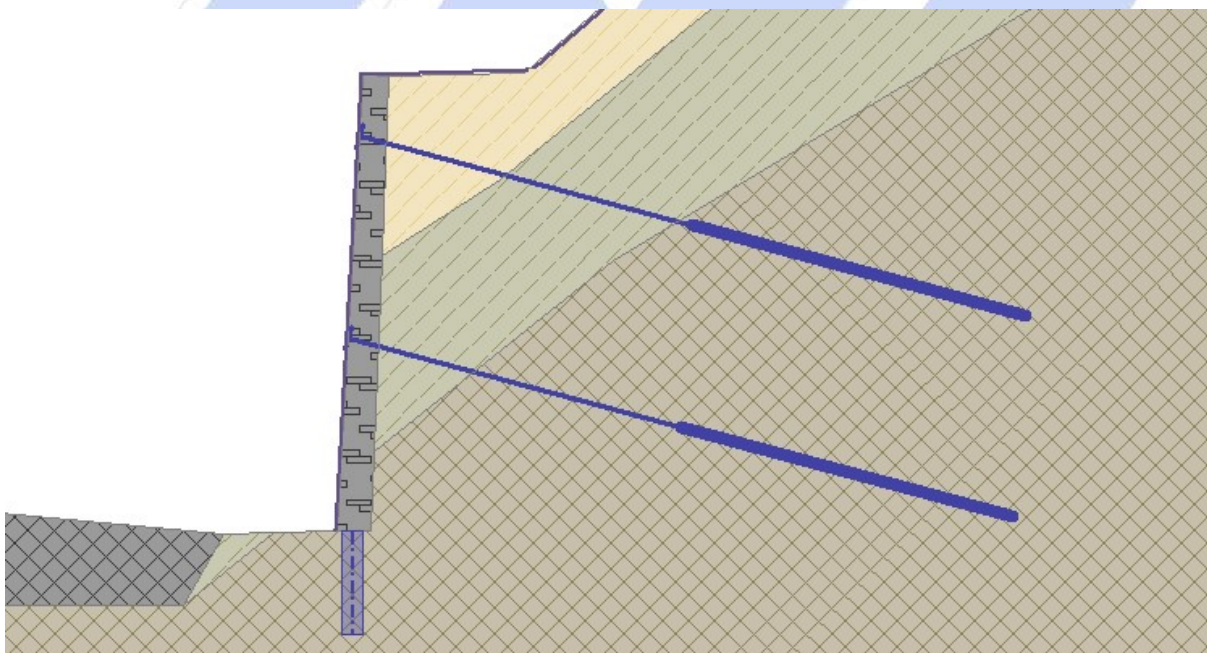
Detalhamento dos tirantes – Fonte: O Autor
